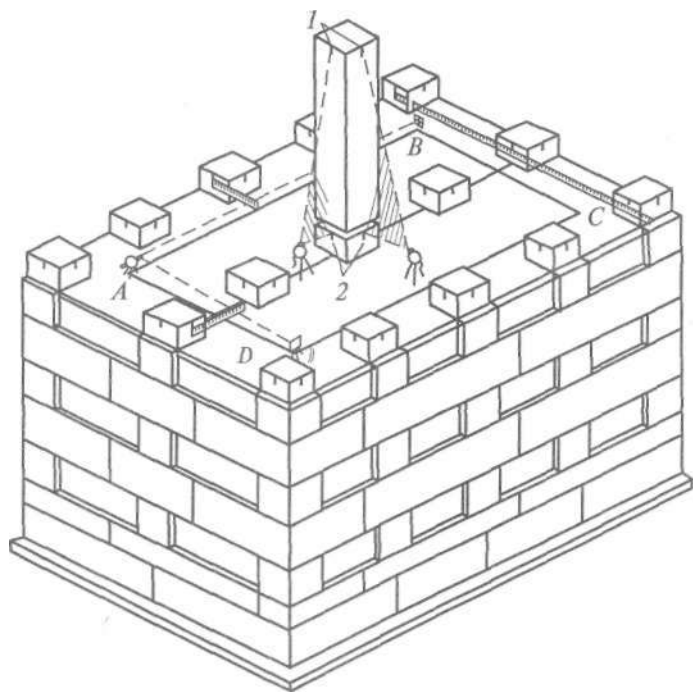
Схема детальной разбивки осей и установки колонн каркасно-панельного здания:
